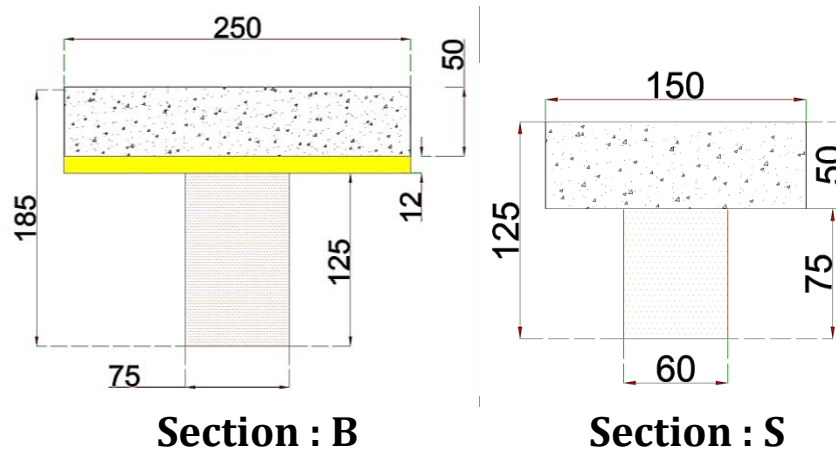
Les sections transversales des poutres mixtes étudiées (Section B) et (Section S).
